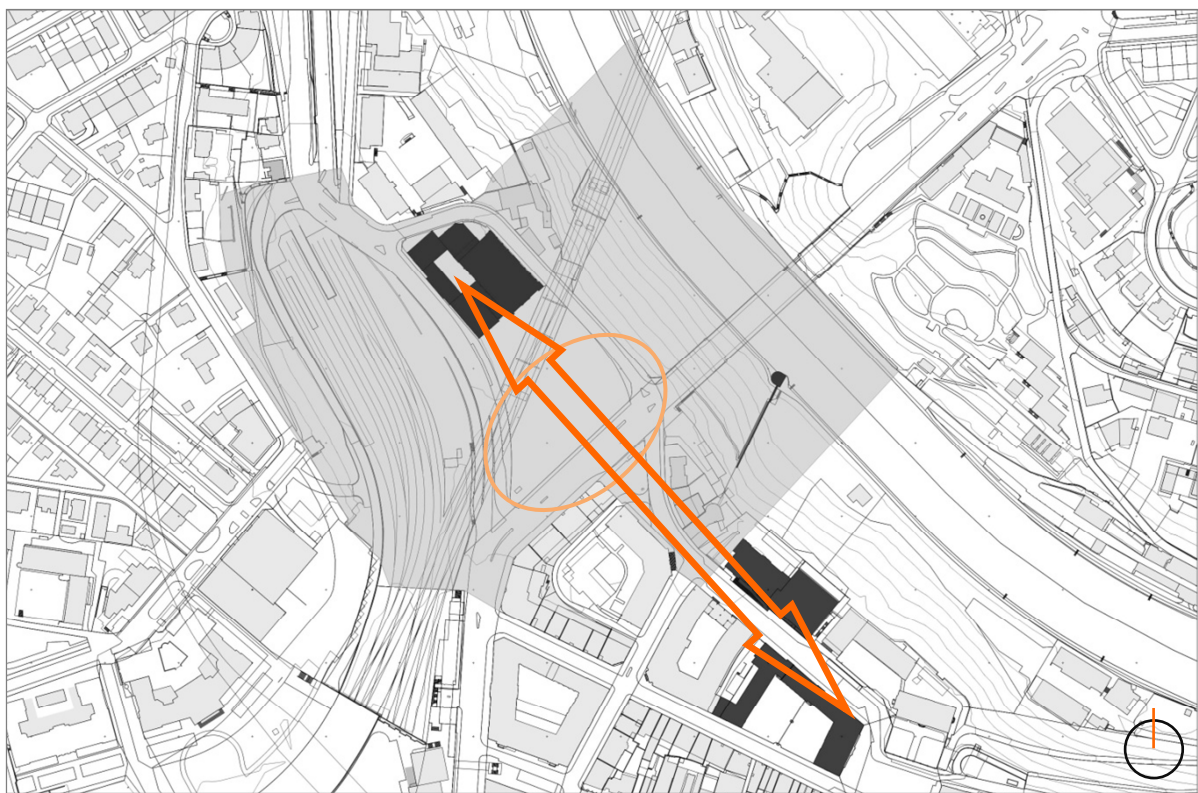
Planta da zona de intervenção com a indicação dos edifícios culturais e reforço do seu alinhamento.
